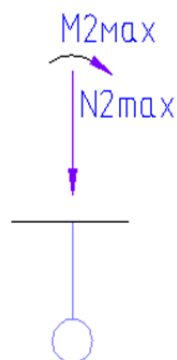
Схема приложения нагрузки от несущих колонн по ряду П в осях 1-21.
